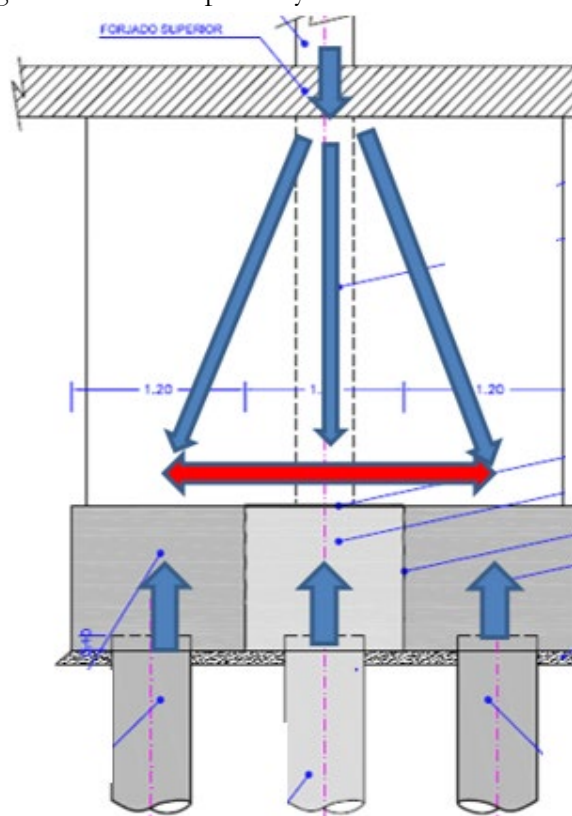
Alzado de recalce de encepado preexistente de 2 pilotes.
